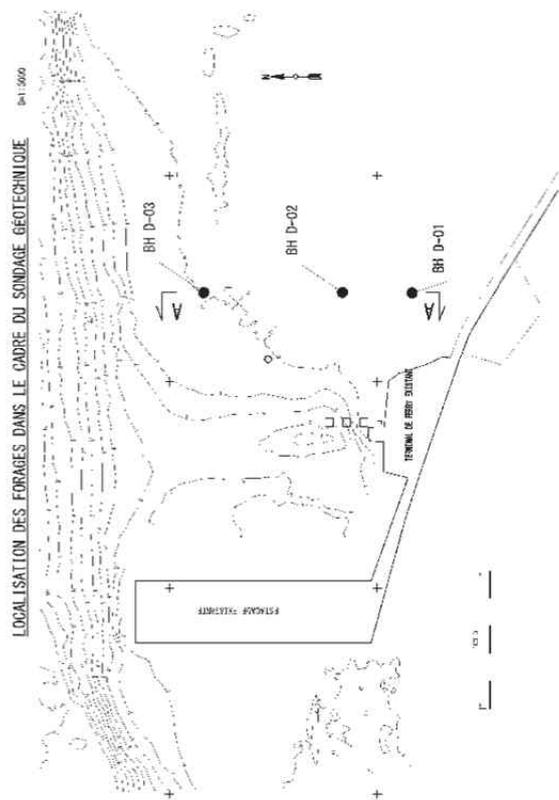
Plan d'ensemble du Port de Djibouti
